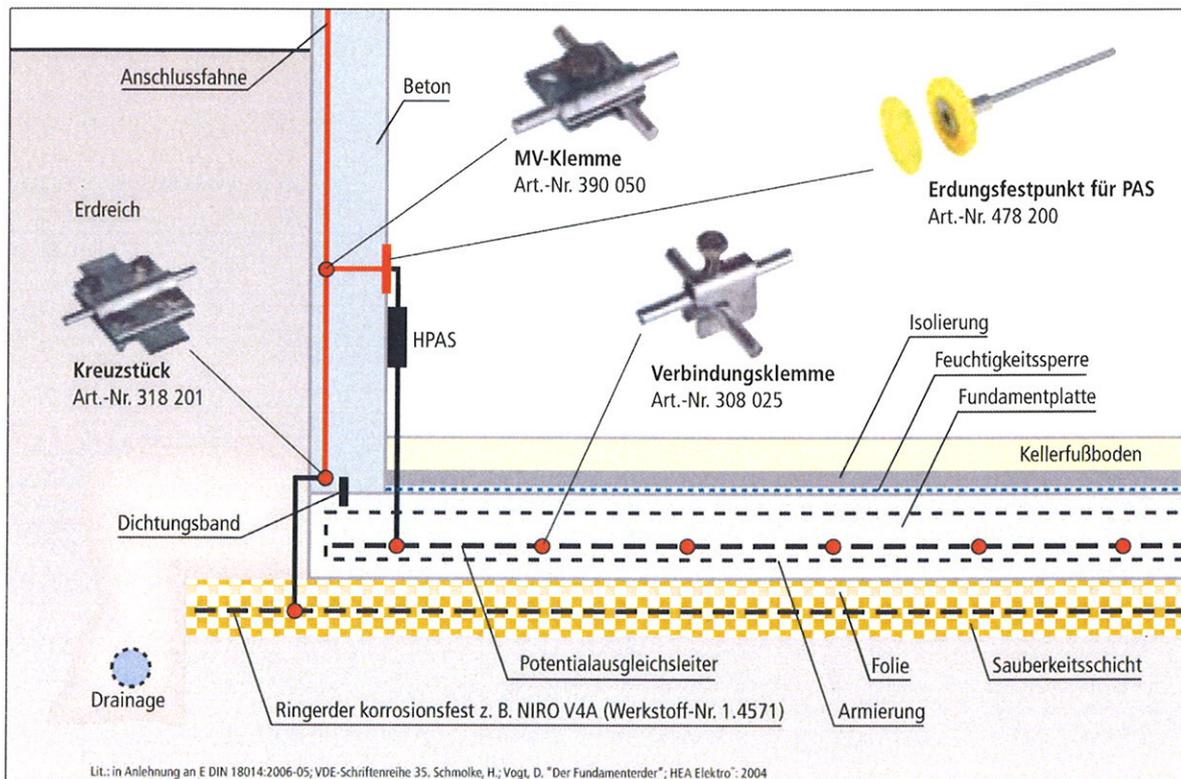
Anordnung des Fundamenterders bei einer geschlossenen Wanne, Ausführung "Weiße Wanne"
